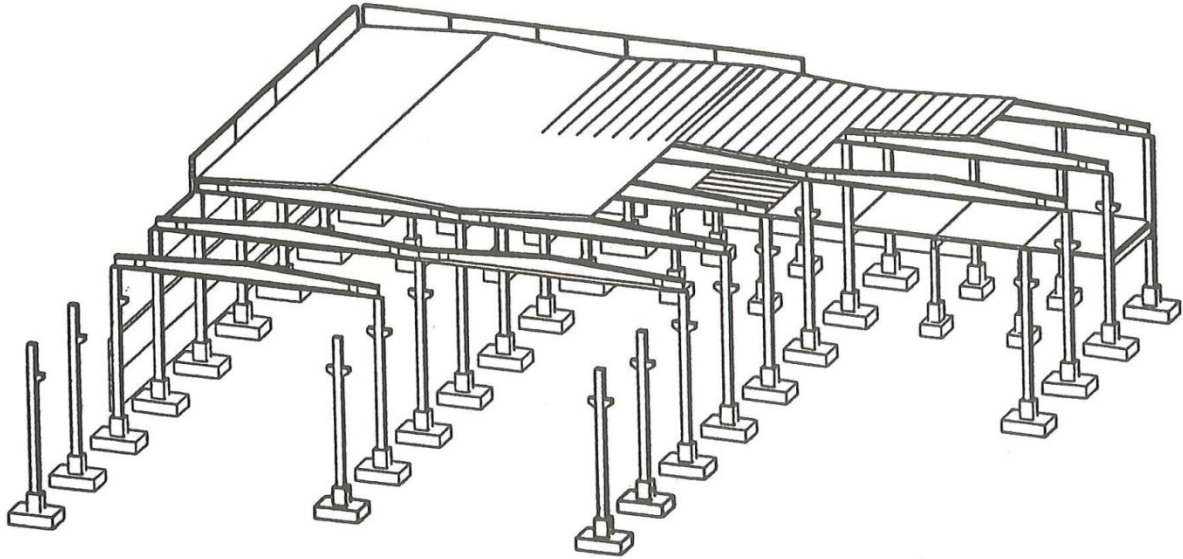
Esimerkki toimisto- ja liikerakennuksen pilari-palkkirungosta, jonka pilari-palkkiliitokset on toteutettu betonikonsoleilla. Julkisivut pääasiassa nauhaelementtejä sekä osittain ruutuelementtejä. (Rakennustuoteteollisuus 1995a)
